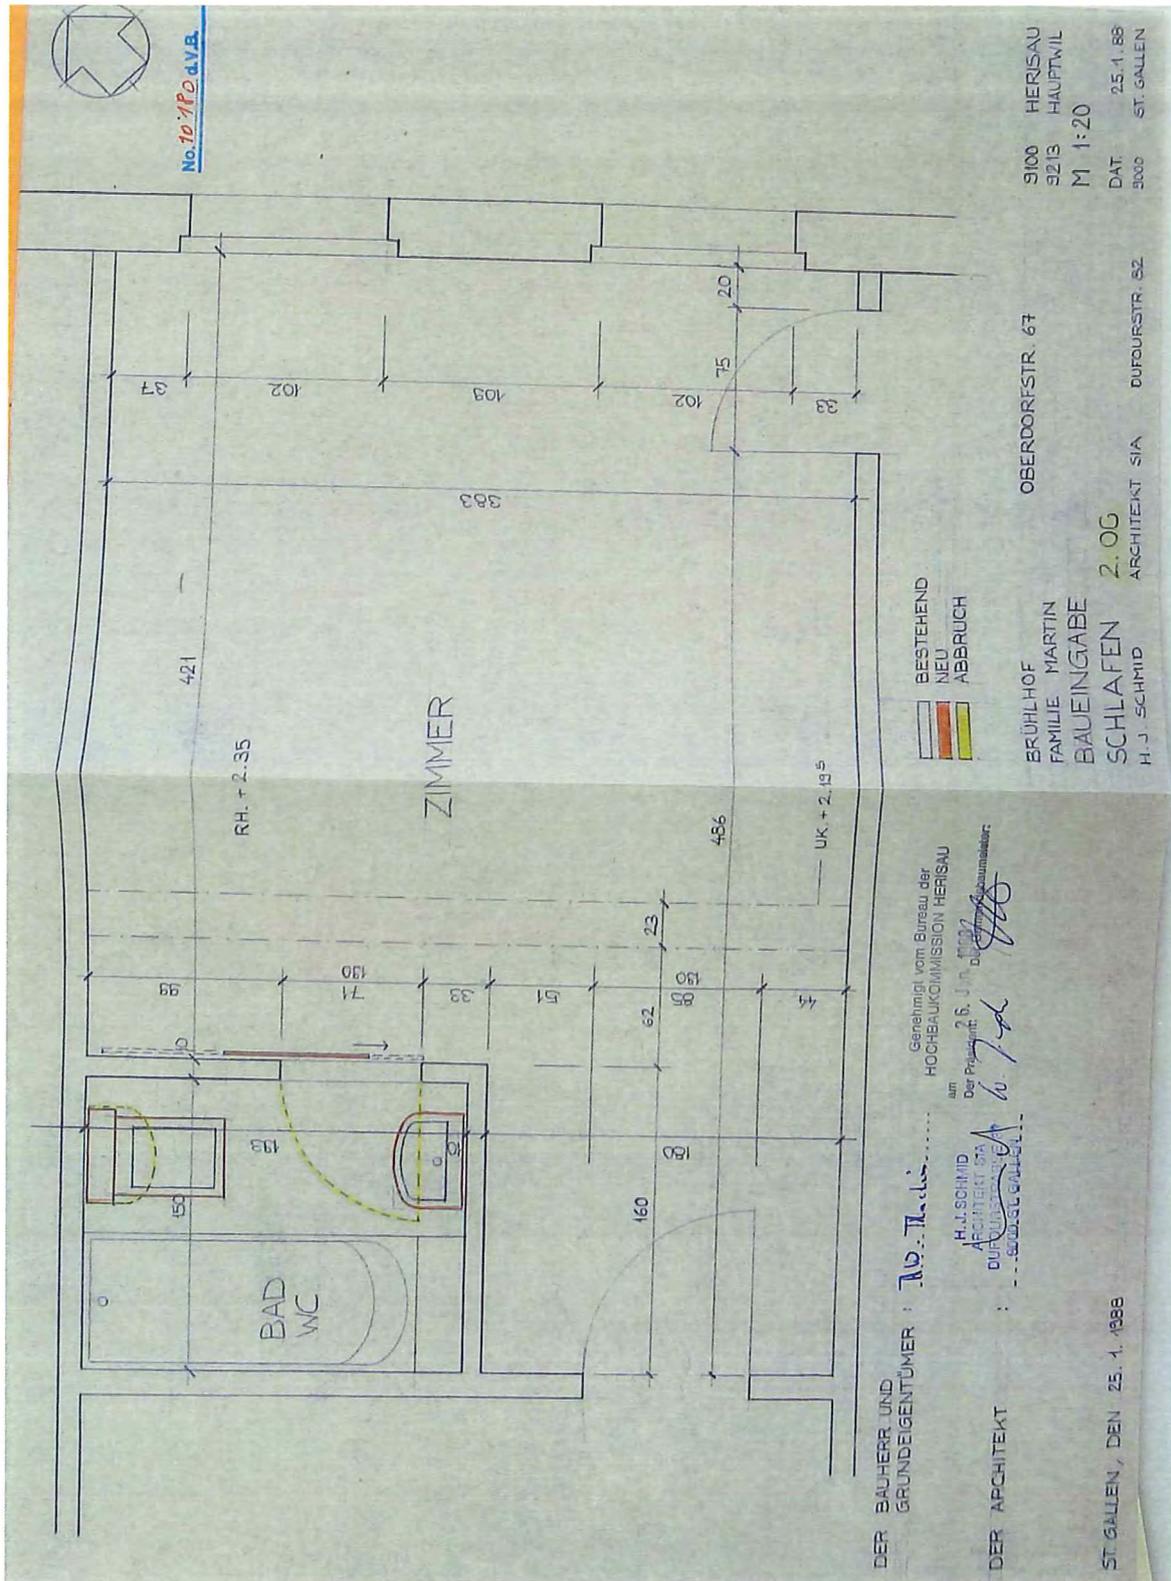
Baueingabe „Sanierung Wohnhaus“ Nr. 10'180 1988, zur Parzelle 523. Baueingabearchiv Gemeinde Herisau. Grundriss 1. Dachgeschoss, Raum 2.10.
